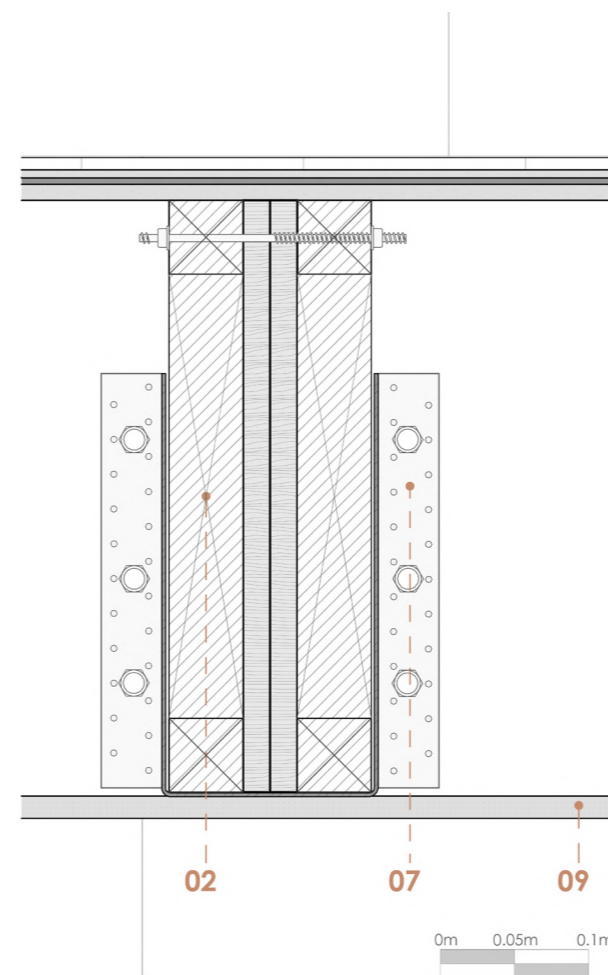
Detalle constructivo del entrepiso mixto I para zonas húmedas
